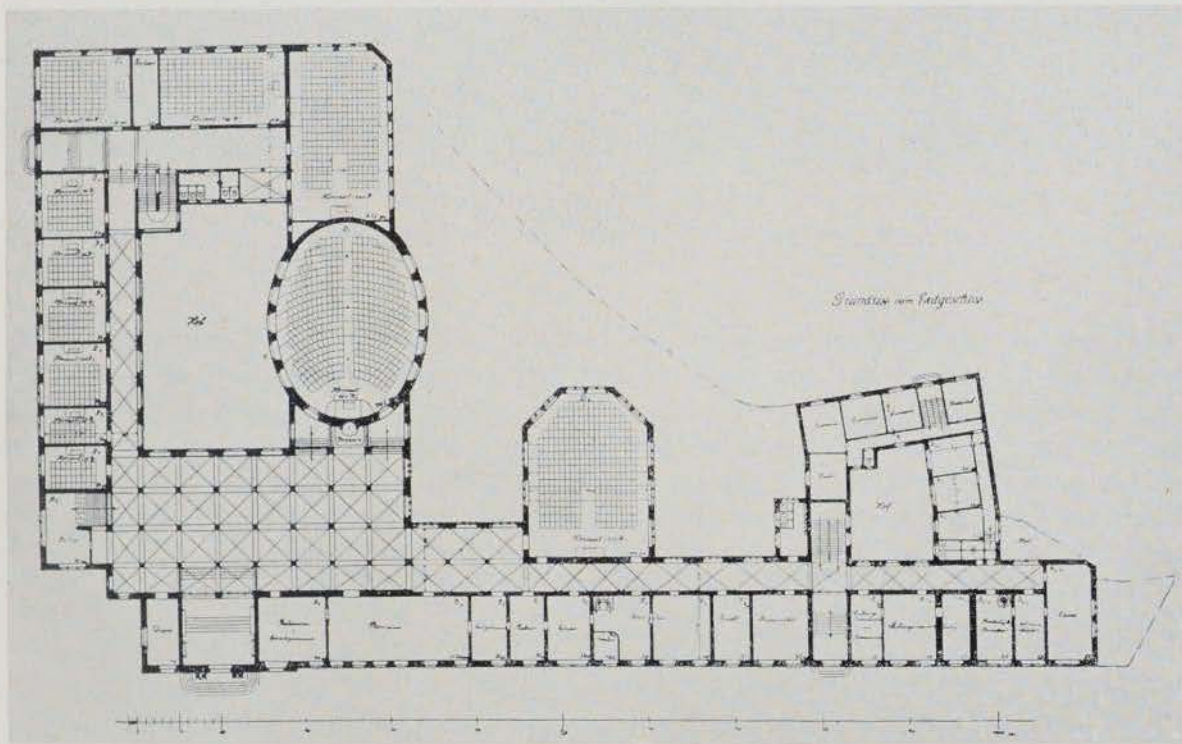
Kollegiengebäude. Erdgeschoßgrundriß
